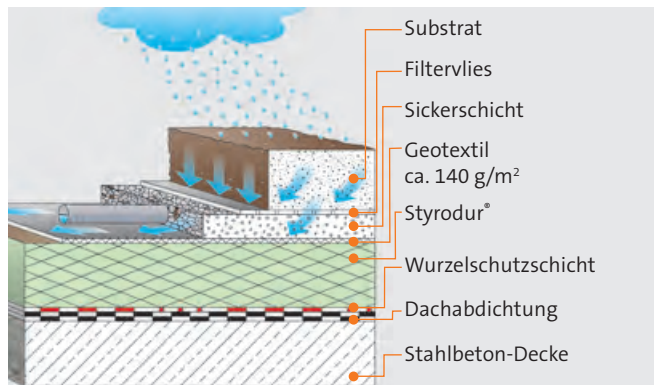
Schichtenaufbau eines begrünten Umkehrdaches mit Dränschicht zur flächigen Wasseraufnahme und alternativ mit Dränleitung.
